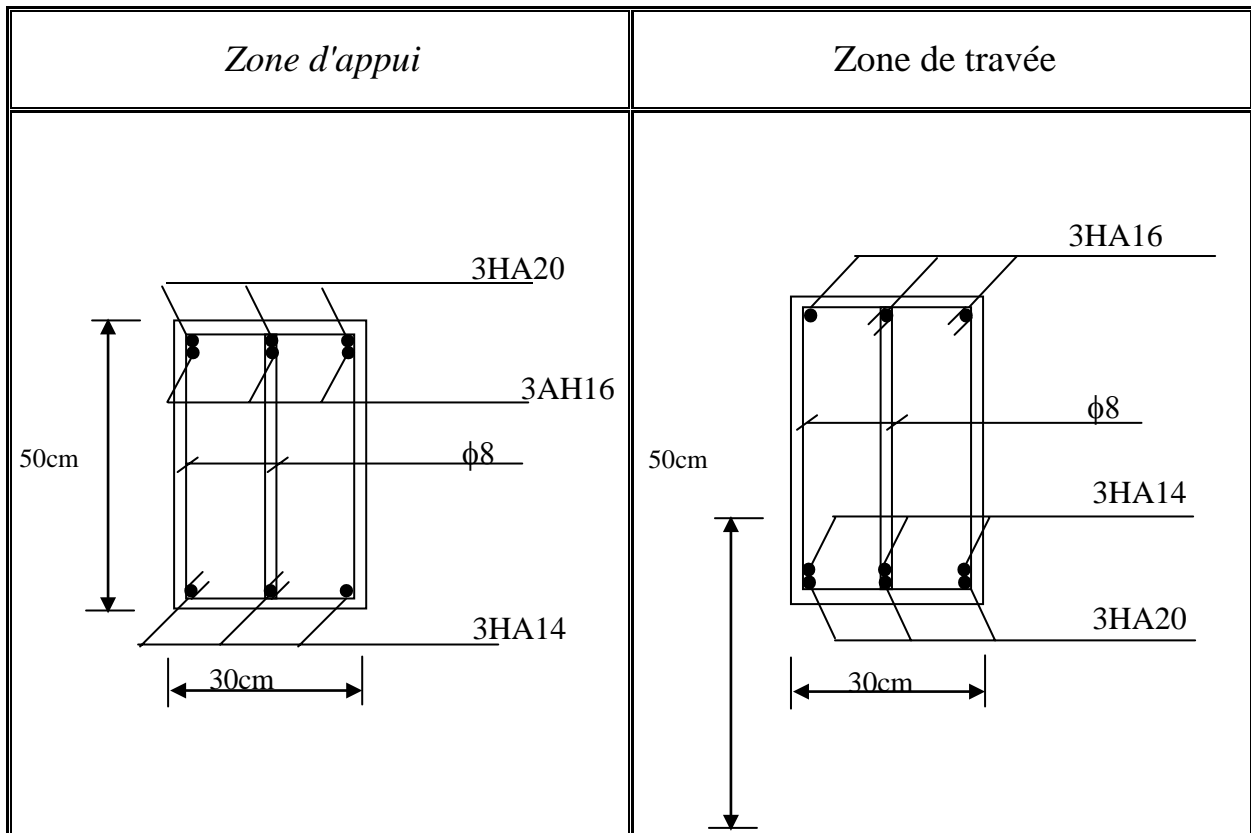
Croquis de ferrailages des poutres principales.
